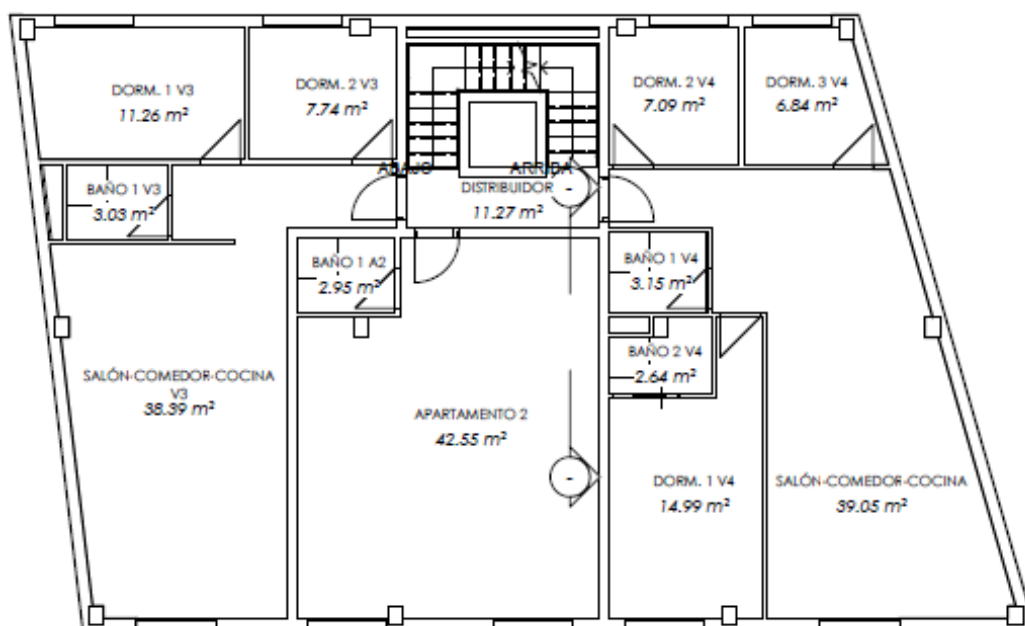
Planta Segunda. Fuente: Propia (2019)
